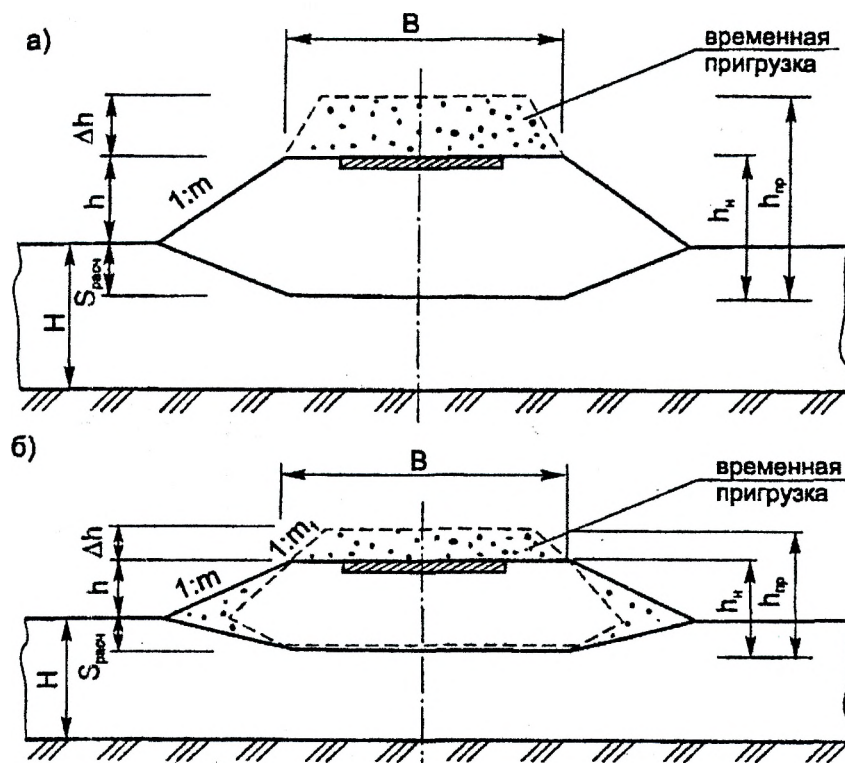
Конструктивные решения земляного полотна с временной пригрузкой: а – в виде дополнительного слоя насыпи – схема А; б – в виде суженной насыпи (насыпь-пригрузка) – схема Б
